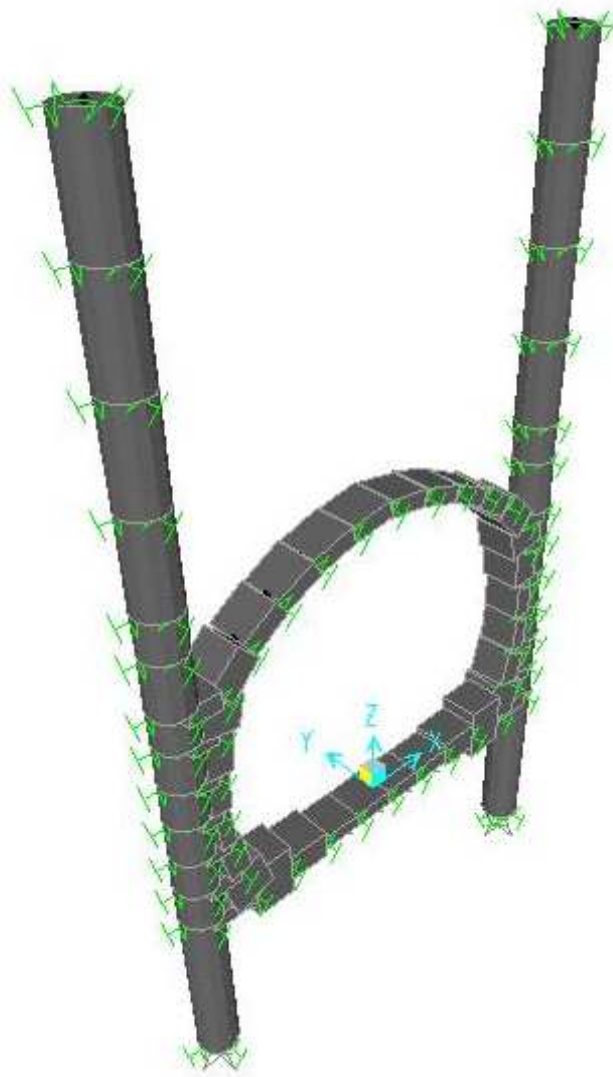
la modélisation des pieux et du tunnel cadre sur SAP2000
